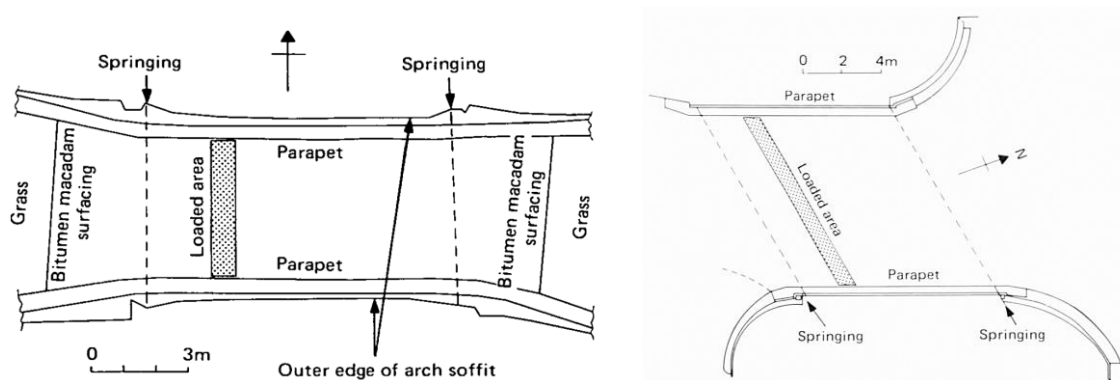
Strathmashie Bridge* (a sinistra) e *Barlae Bridge* (a destra): planimetria con indicazione dell'area caricata. [49]
